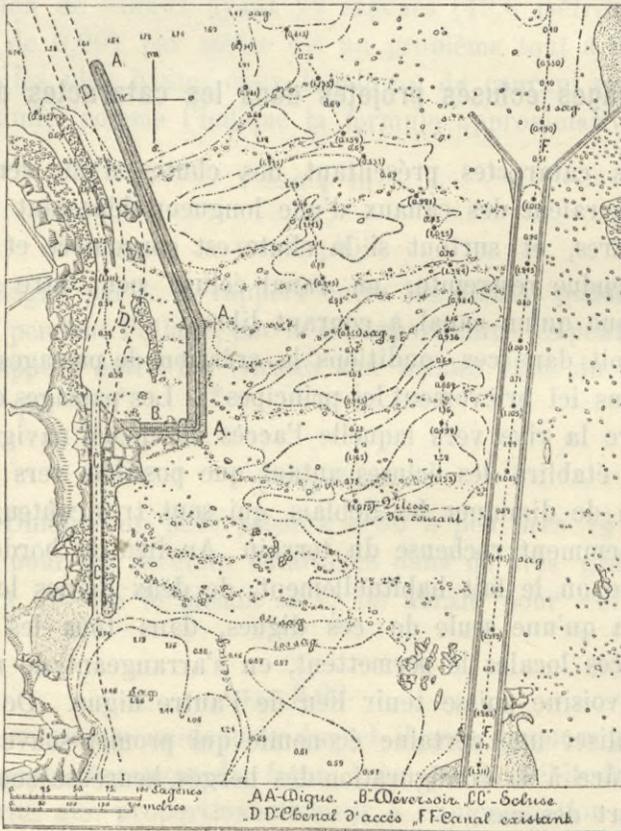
Plan des ouvrages projetés pour la traversée de l'Insatiable.
